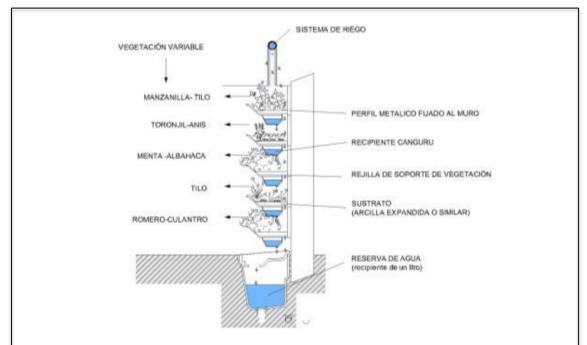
Detalle diseñado en elevación de vegetación vertical Ecotelhado-Sistem Canguru.
